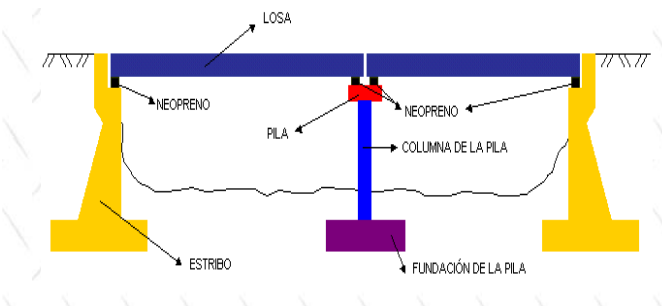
Puente de losa maciza de concreto armado
